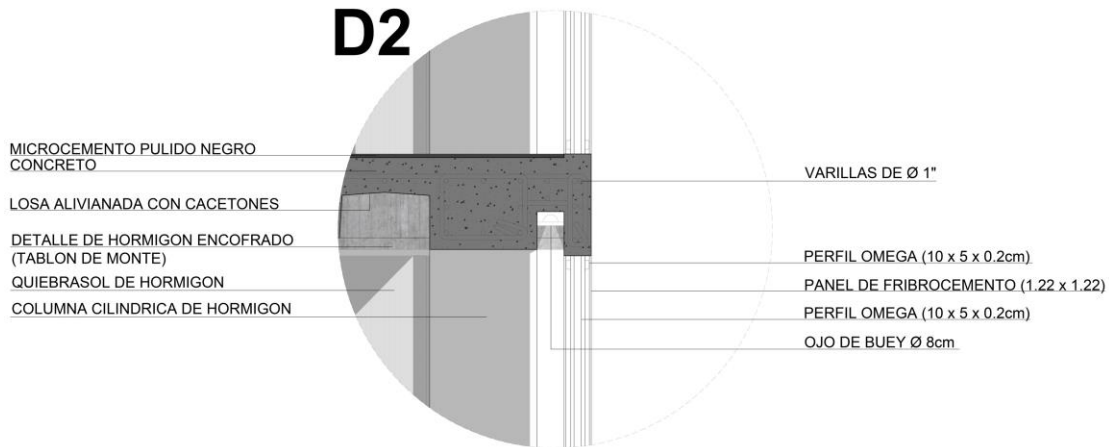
Detalle 2. Corte por fachada 2. Elaboración propia.
